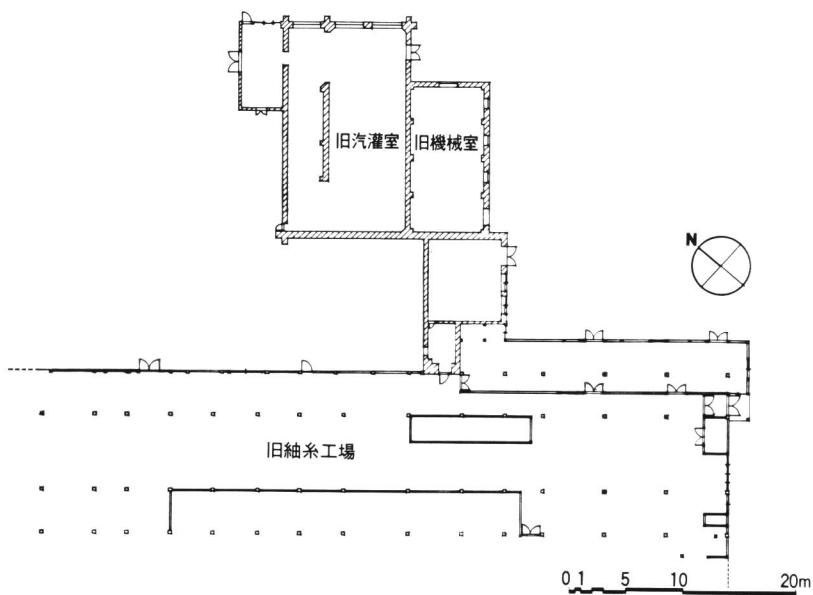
旧汽灌室・旧機械室・旧紬糸工場（一部）実測平面図
